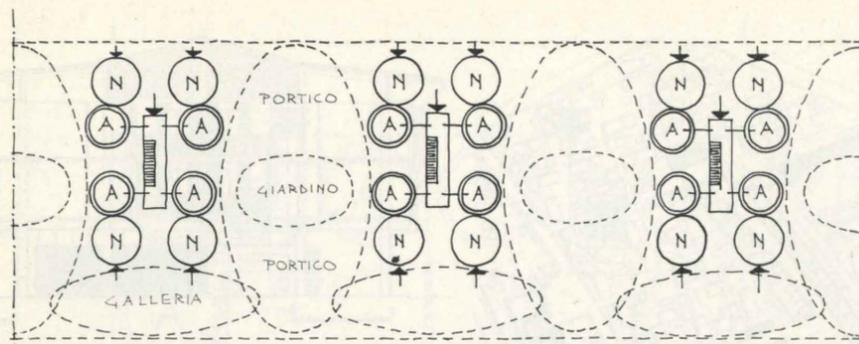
Schema dell'edificio dell'illustrazione precedente.
